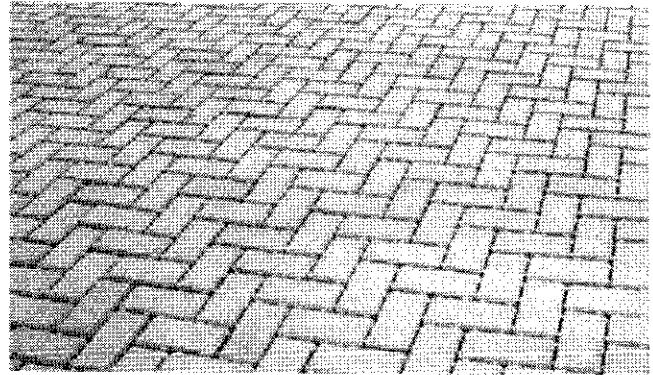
Pavimento intertravado permeável com juntas alargadas
